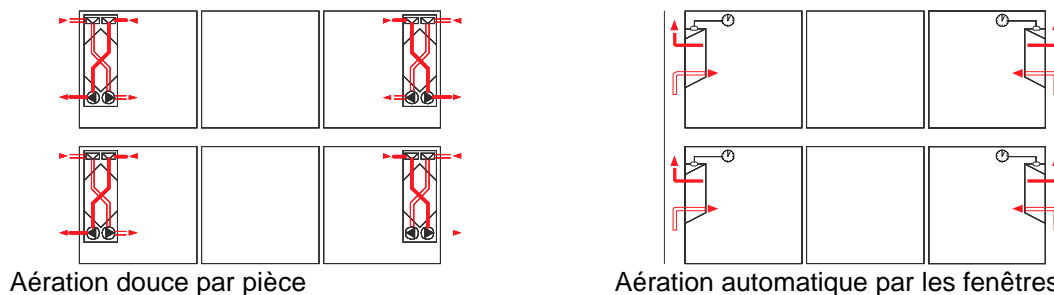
Choix des installations de ventilation comme « type d'installation de ventilation standard »
